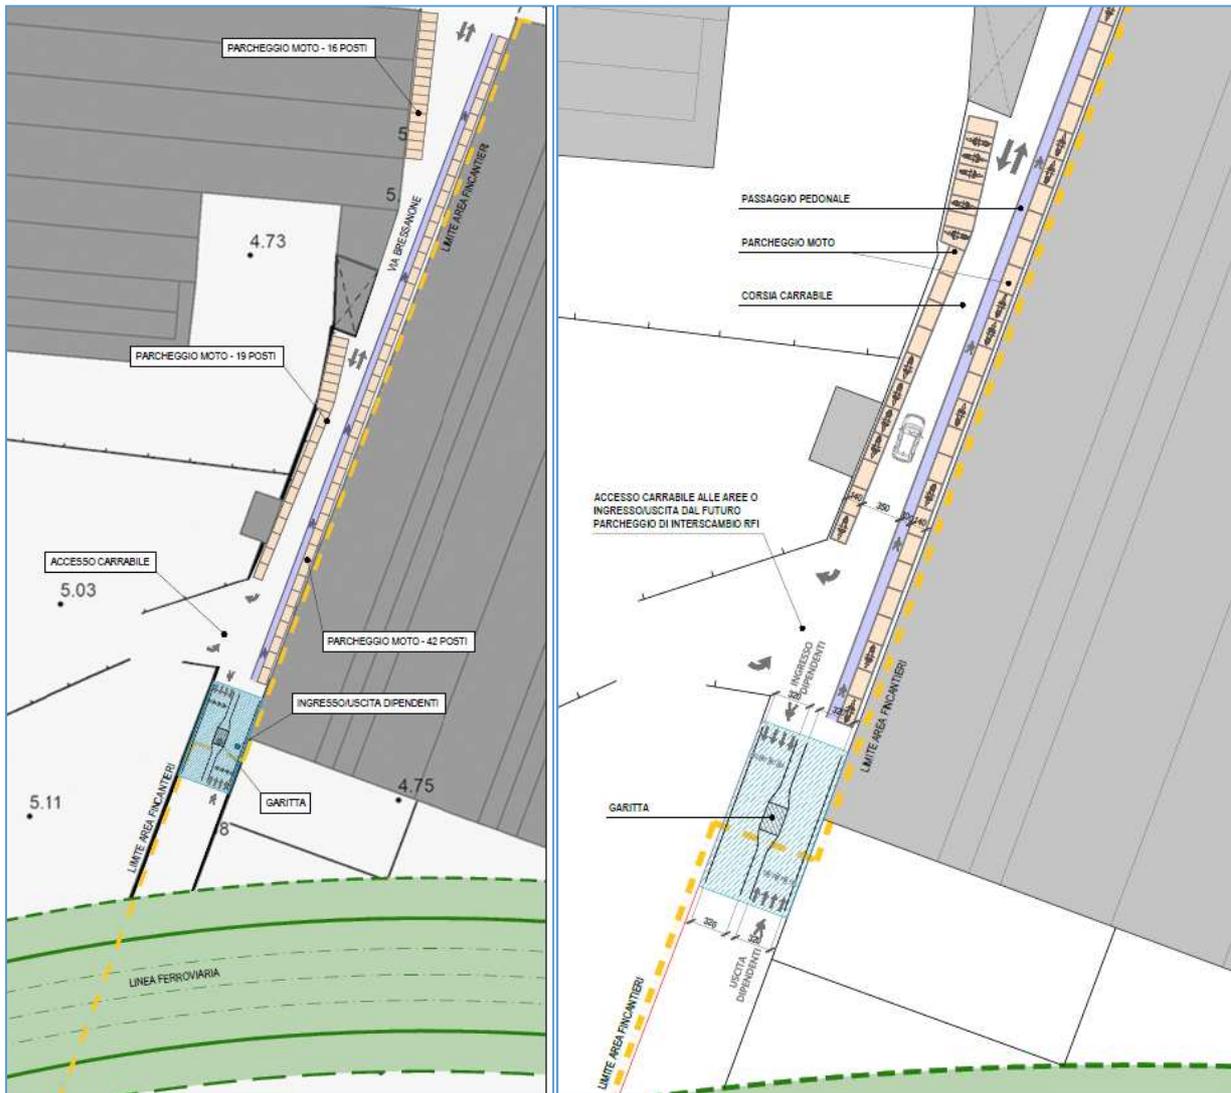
vista di via Bressanone e particolare del varco Bressanone
